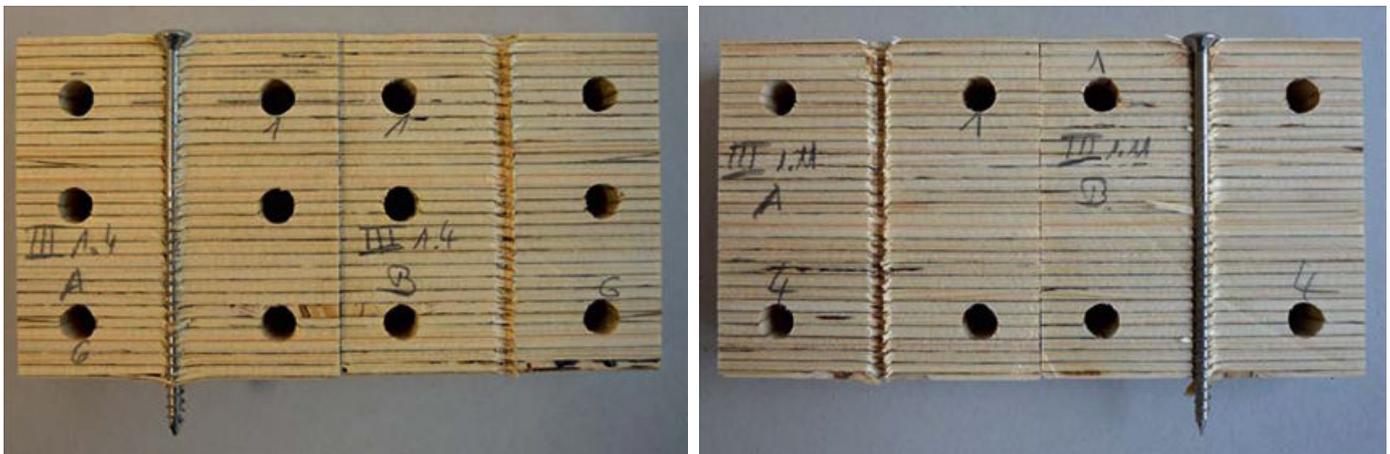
Prüfkörper aus Furnierschichtholz für Versuche mit Schrauben kleinerer Durchmesser
